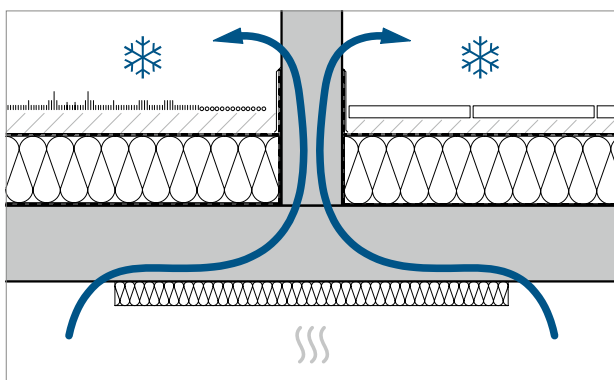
Pos ④: Wärmefluss bei Dachaufbau mit Flankendämmung
